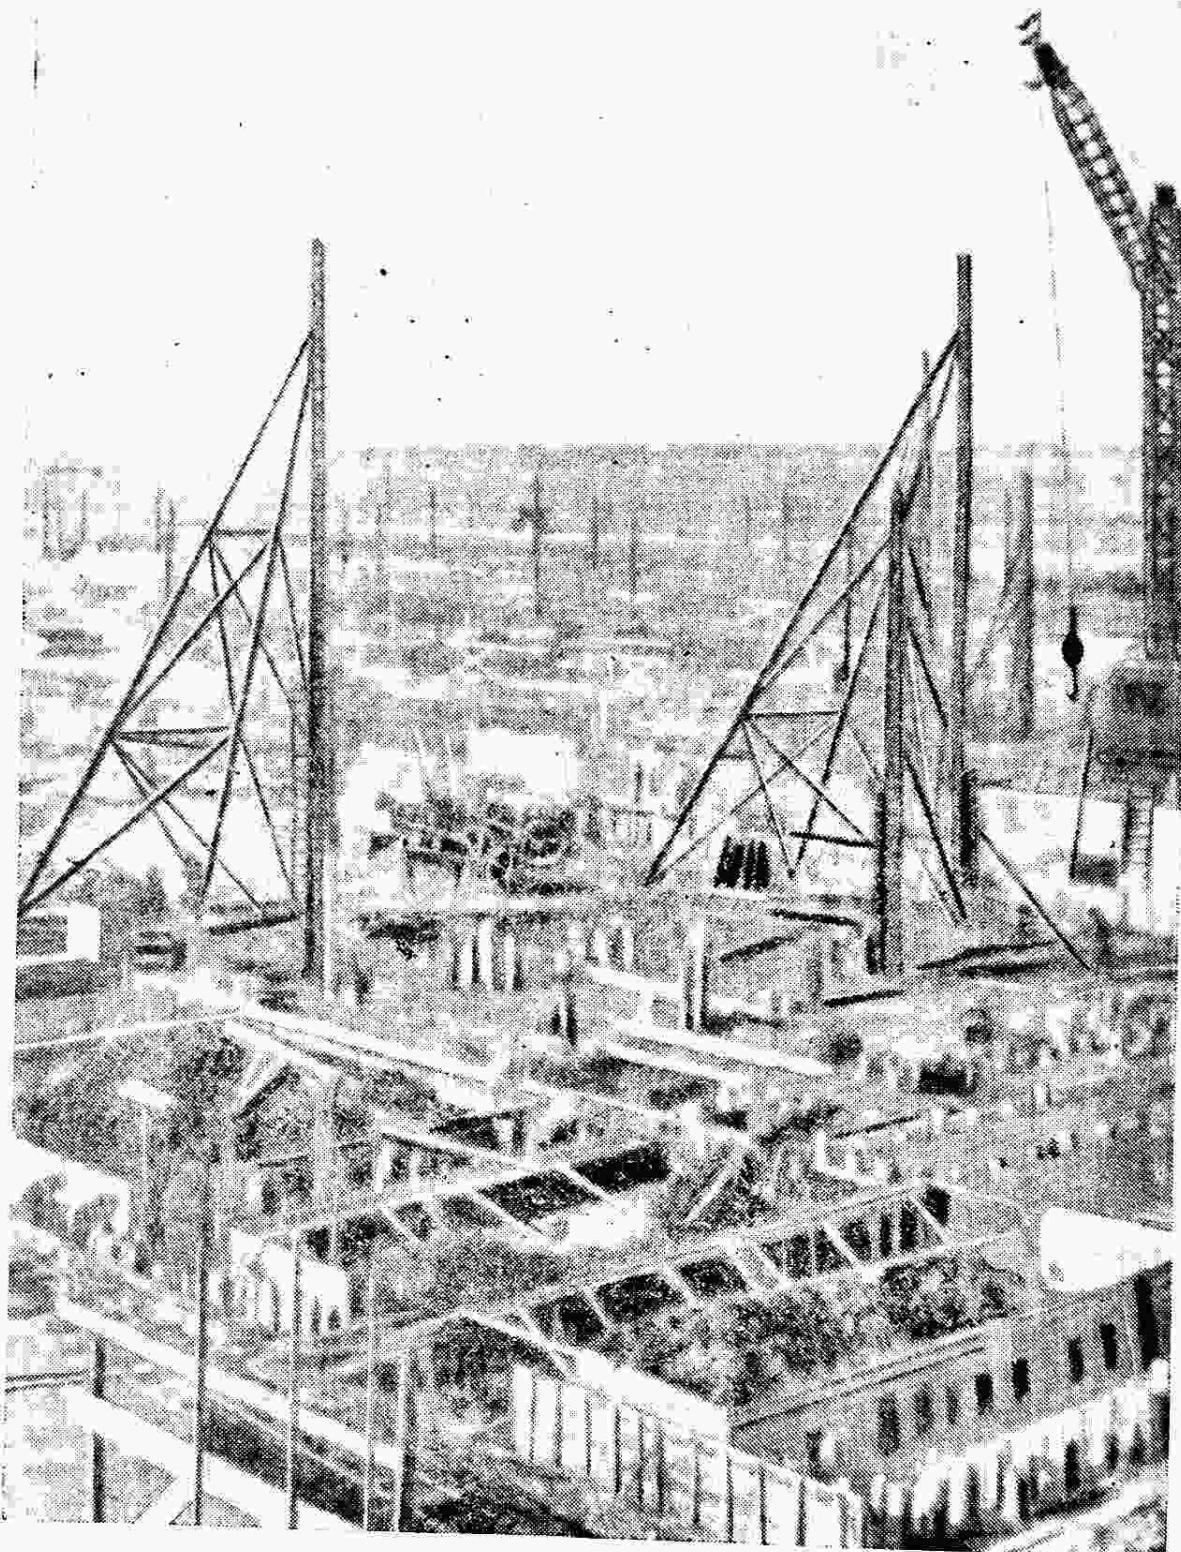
Забивка свай для фундаментов стоек (на переднем плане, с правой стороны видны сваи в два ряда в виде шпунта)
